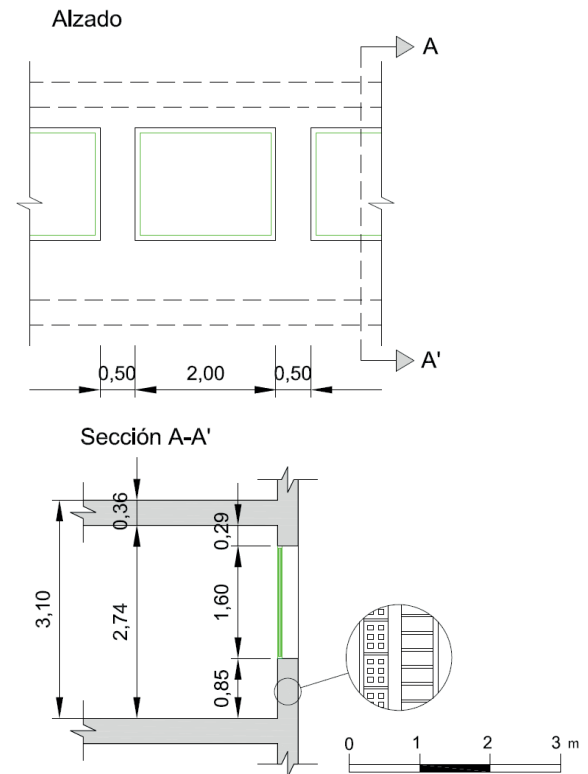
Alzado y sección fachada del edificio modelo inicial. Fuente: Elaboración de los autores.
